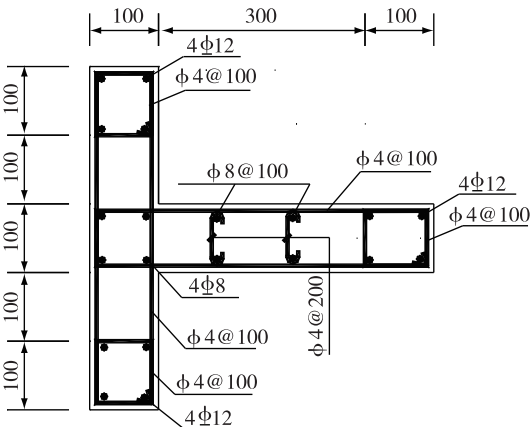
T 形 RAC 短肢剪力墙配筋(单位:mm)
